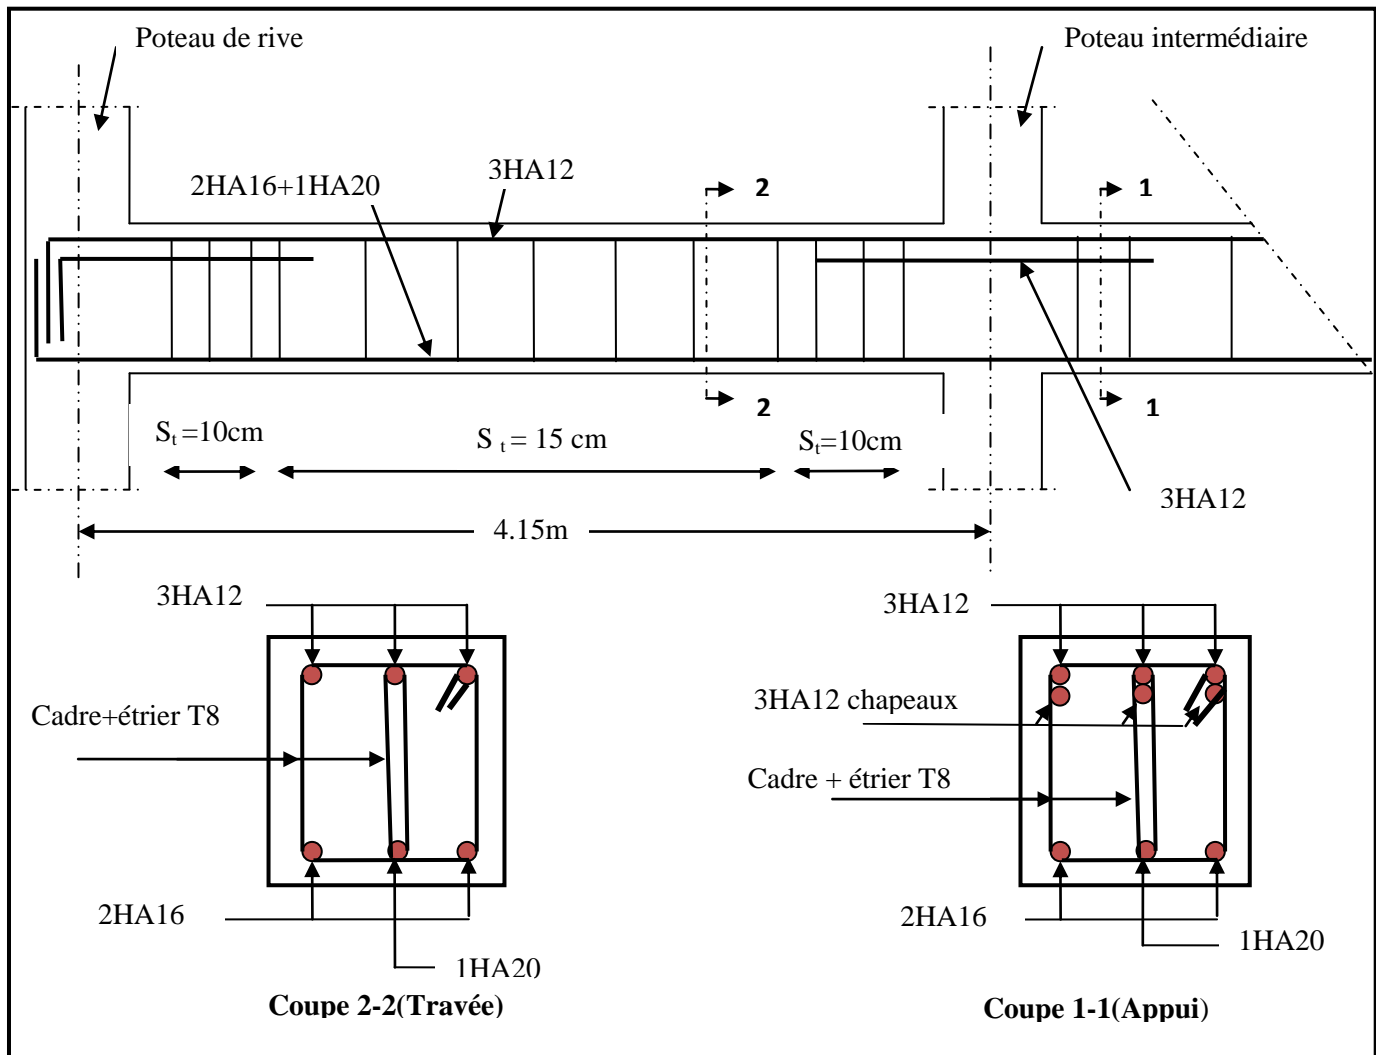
Ferrailage des poutres secondaires des étages services.
